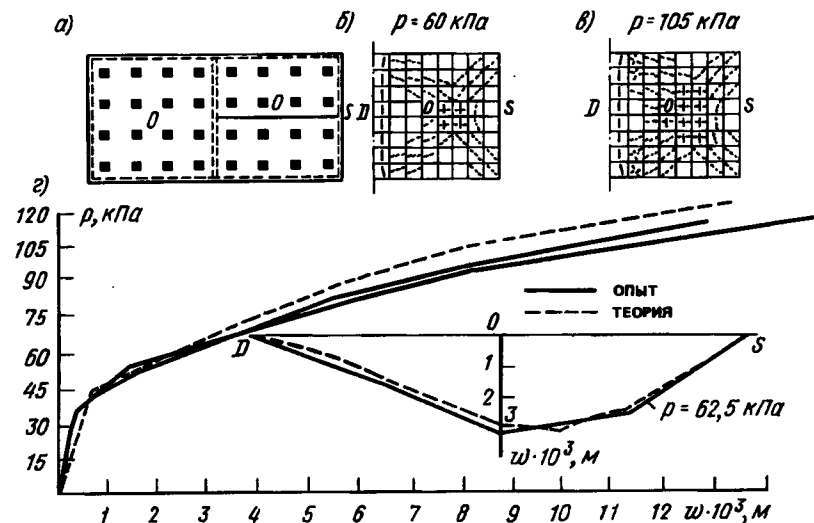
Расчет двухпролетной неразрезной плиты перекрытия
